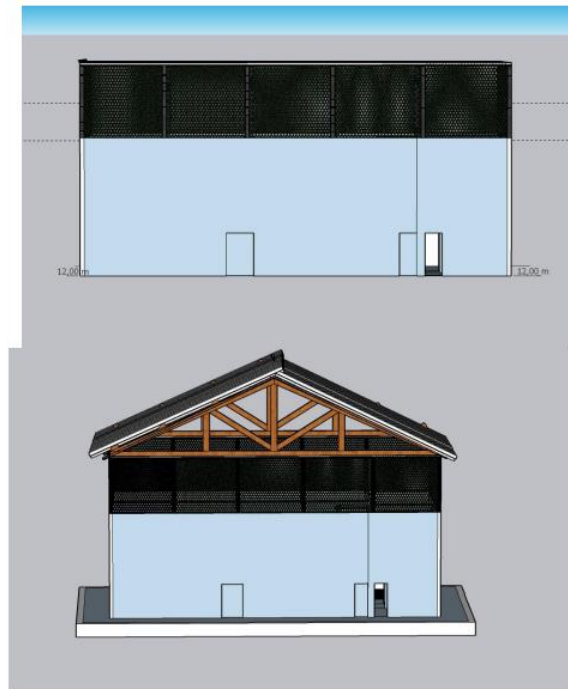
Denah Gedung Penampungan Sementara Limbah B3 TFME
